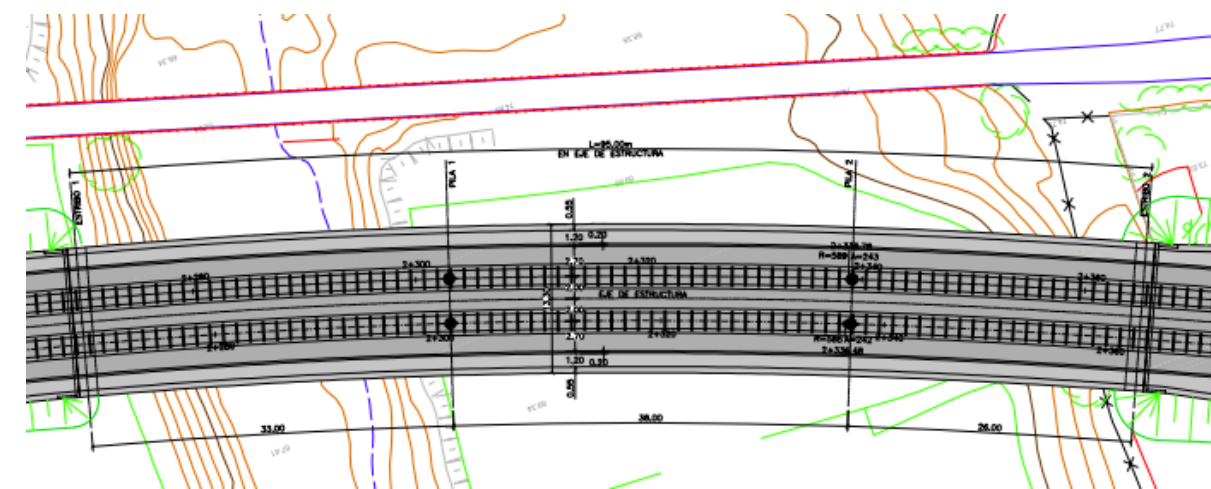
PLANTA VIADUCTO SOBRE BARRANCO BARBASENA P.K. 2+320
